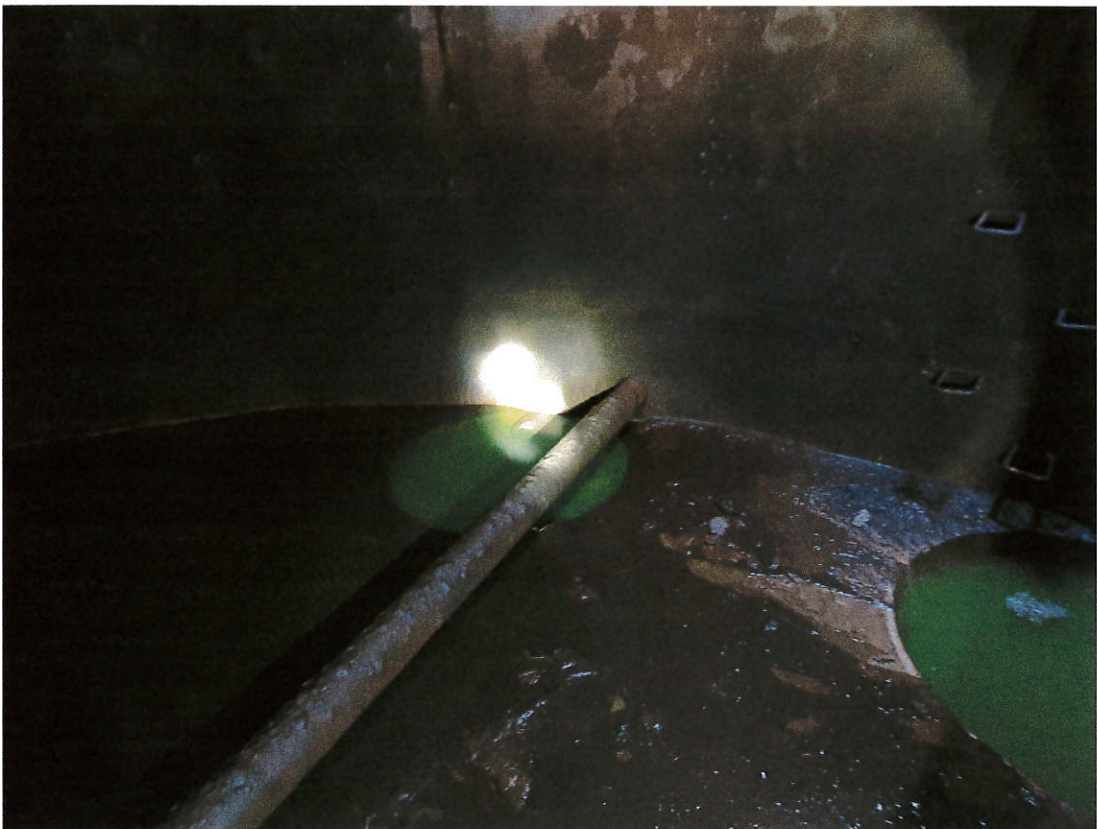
Płyta stropowa – widoczne zbrojenie
